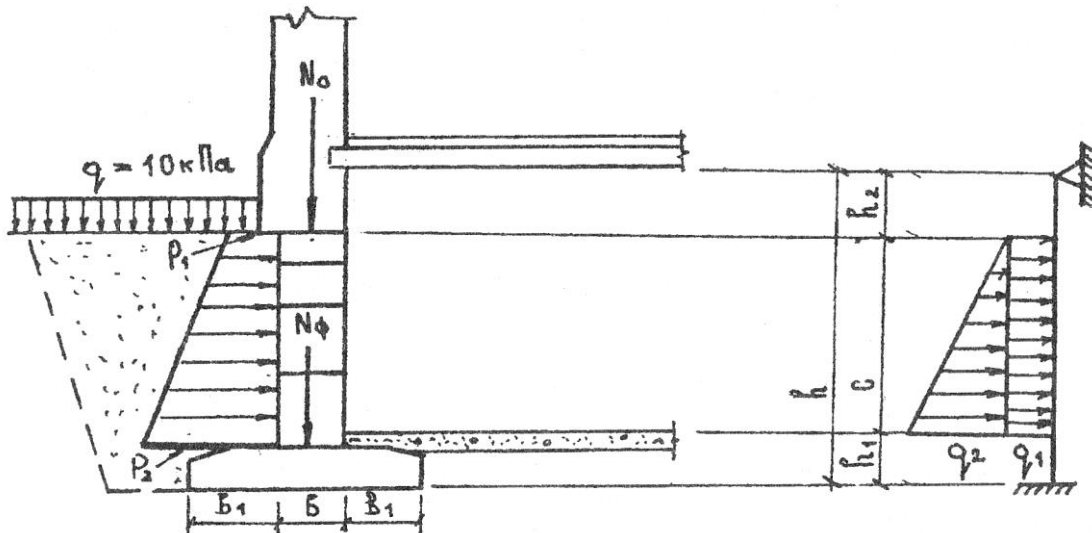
Определение нагрузок на основание ленточного фундамента
